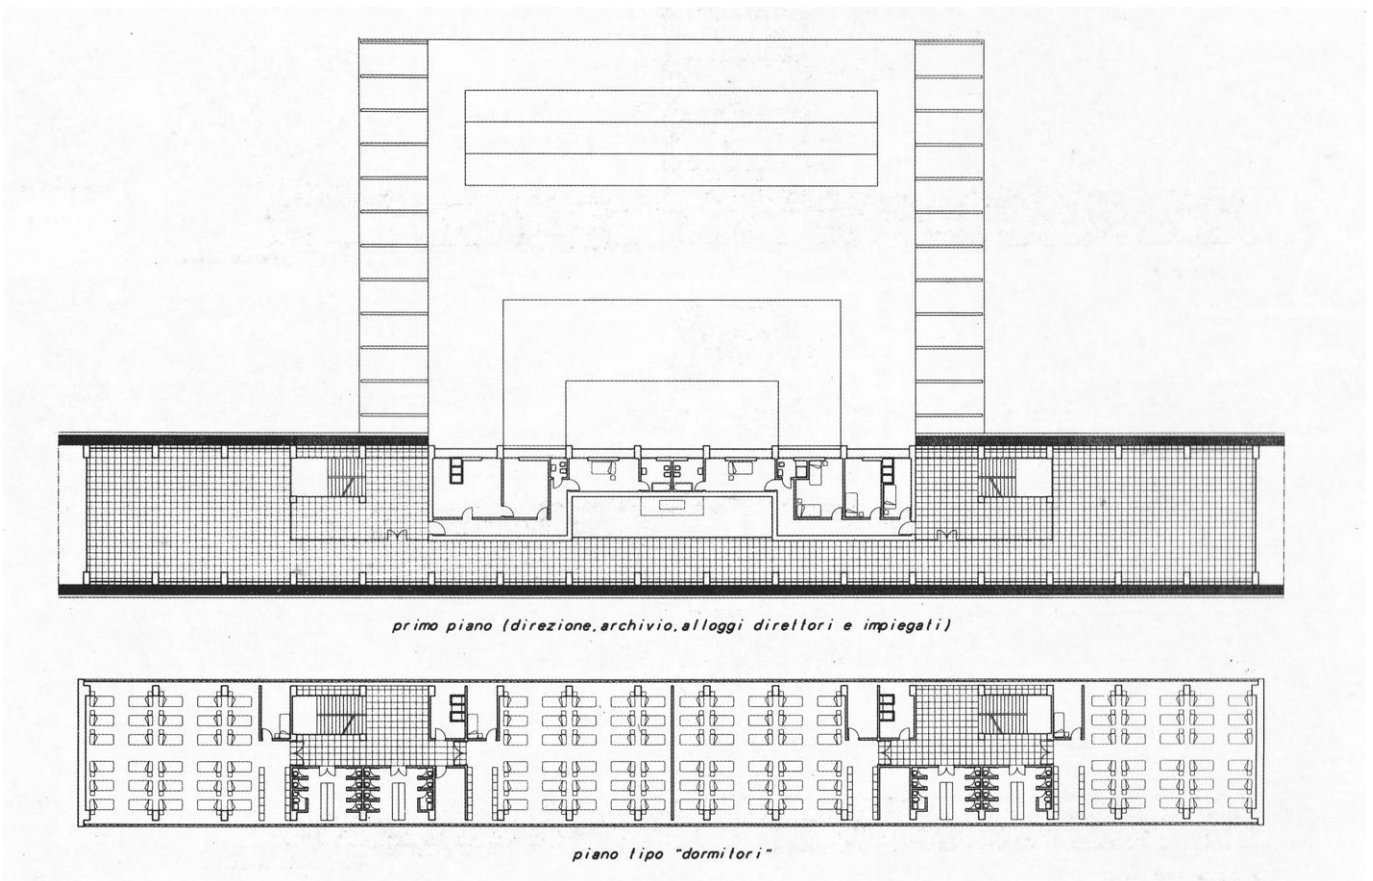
piano terra e piano tipo dormitori, 1938, Archivio Vaccaro
